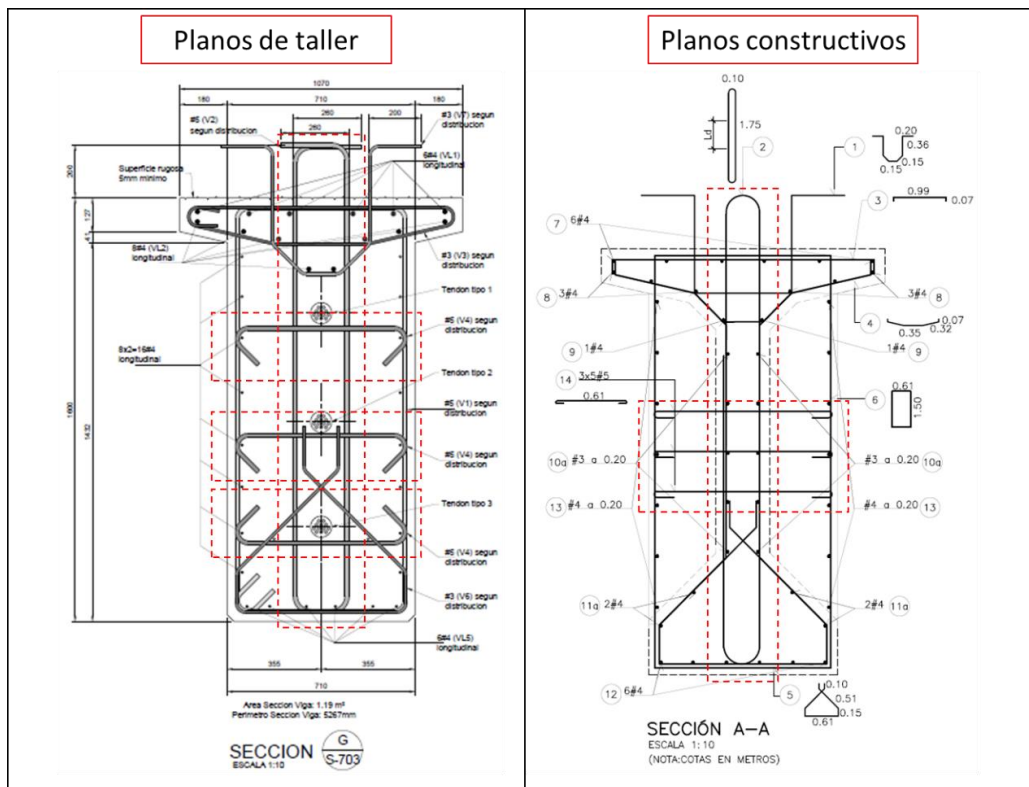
Diferencias en viga de superestructura n.º 5 entre planos de taller y planos constructivos
